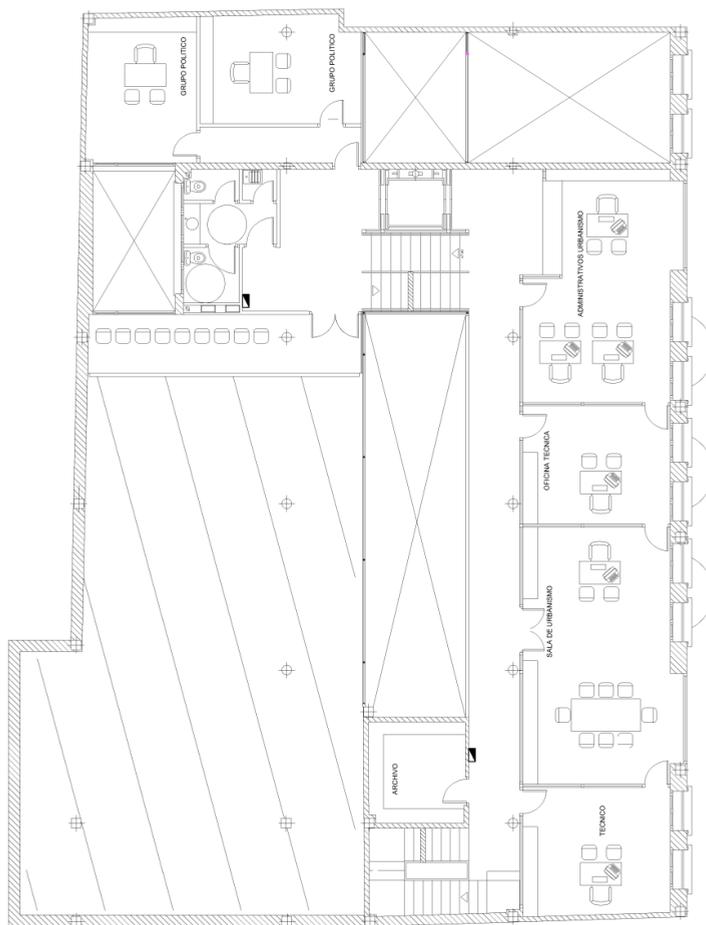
Distribución de Plantas Cuarta y Quinta. 2002. AutoCAD.
